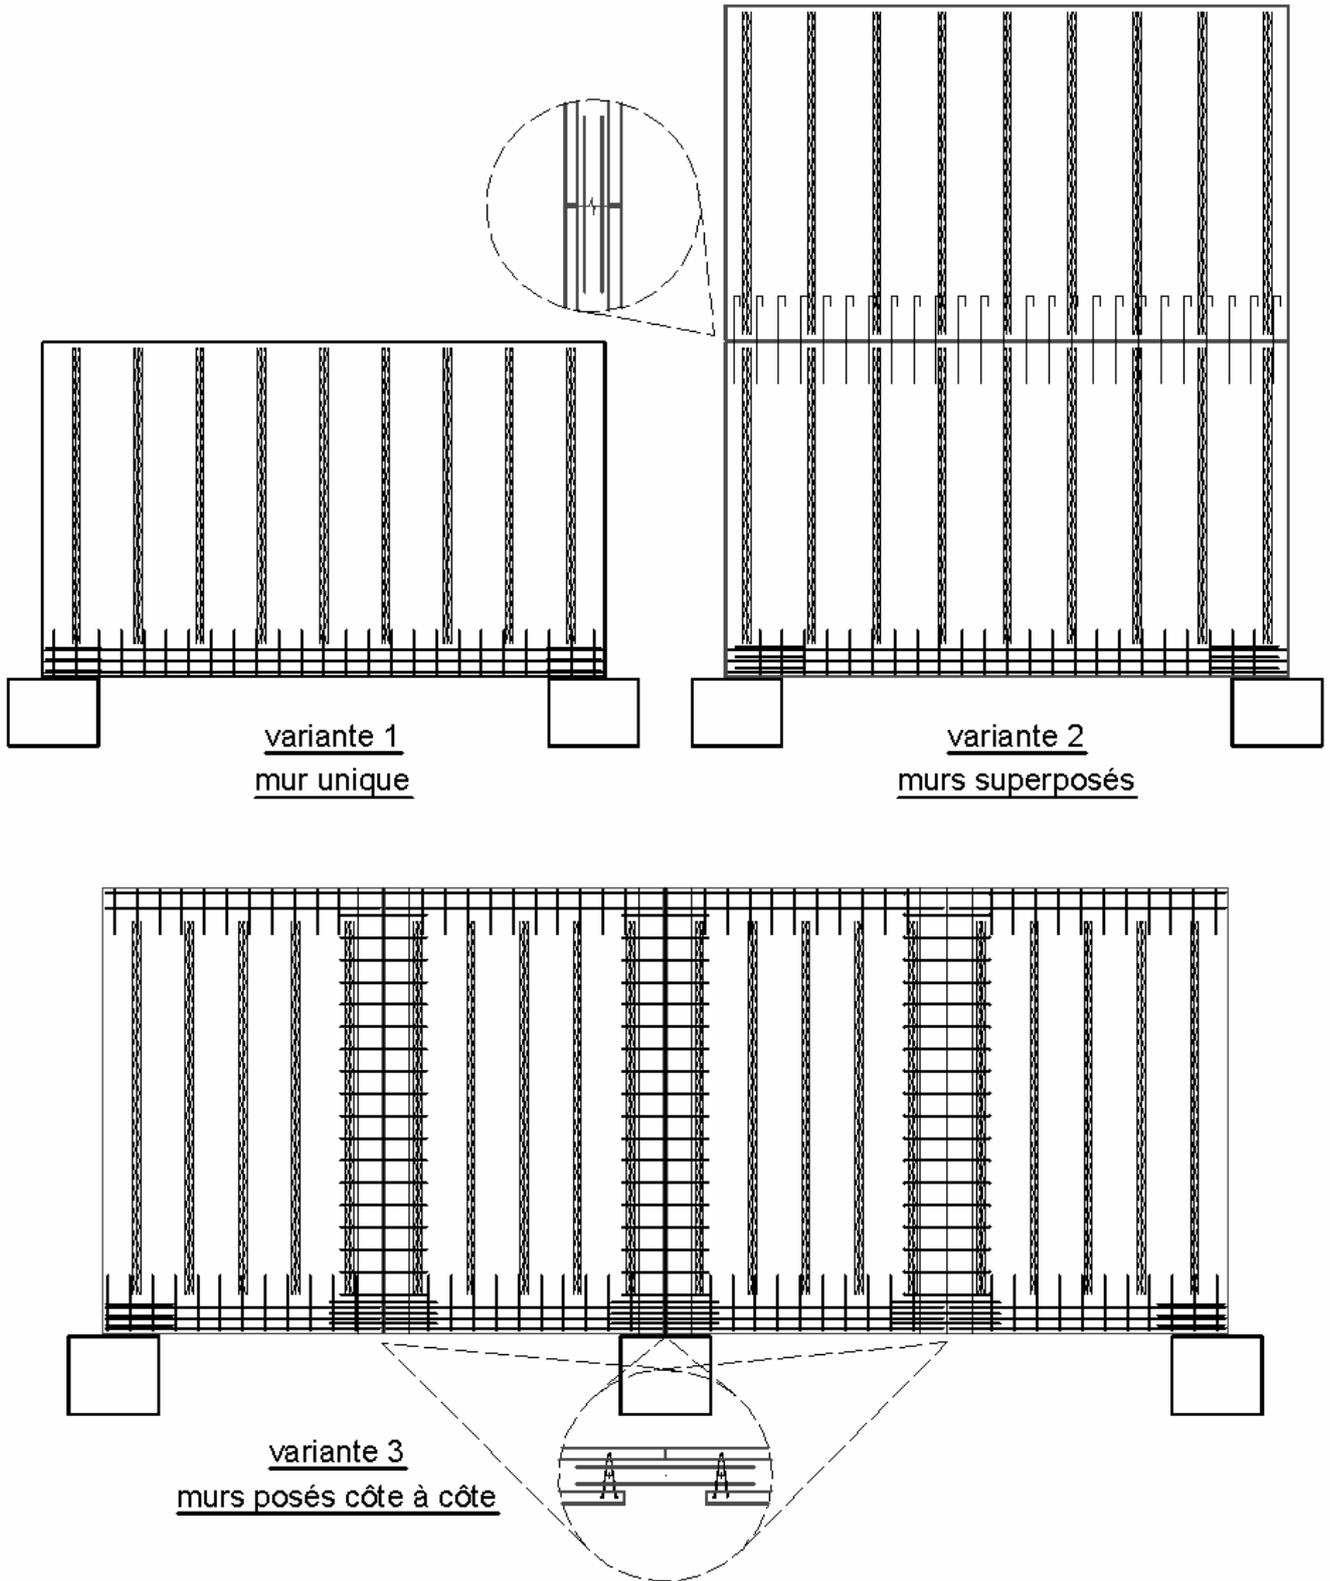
POTEAUX ET POUTRES UNIMURs
